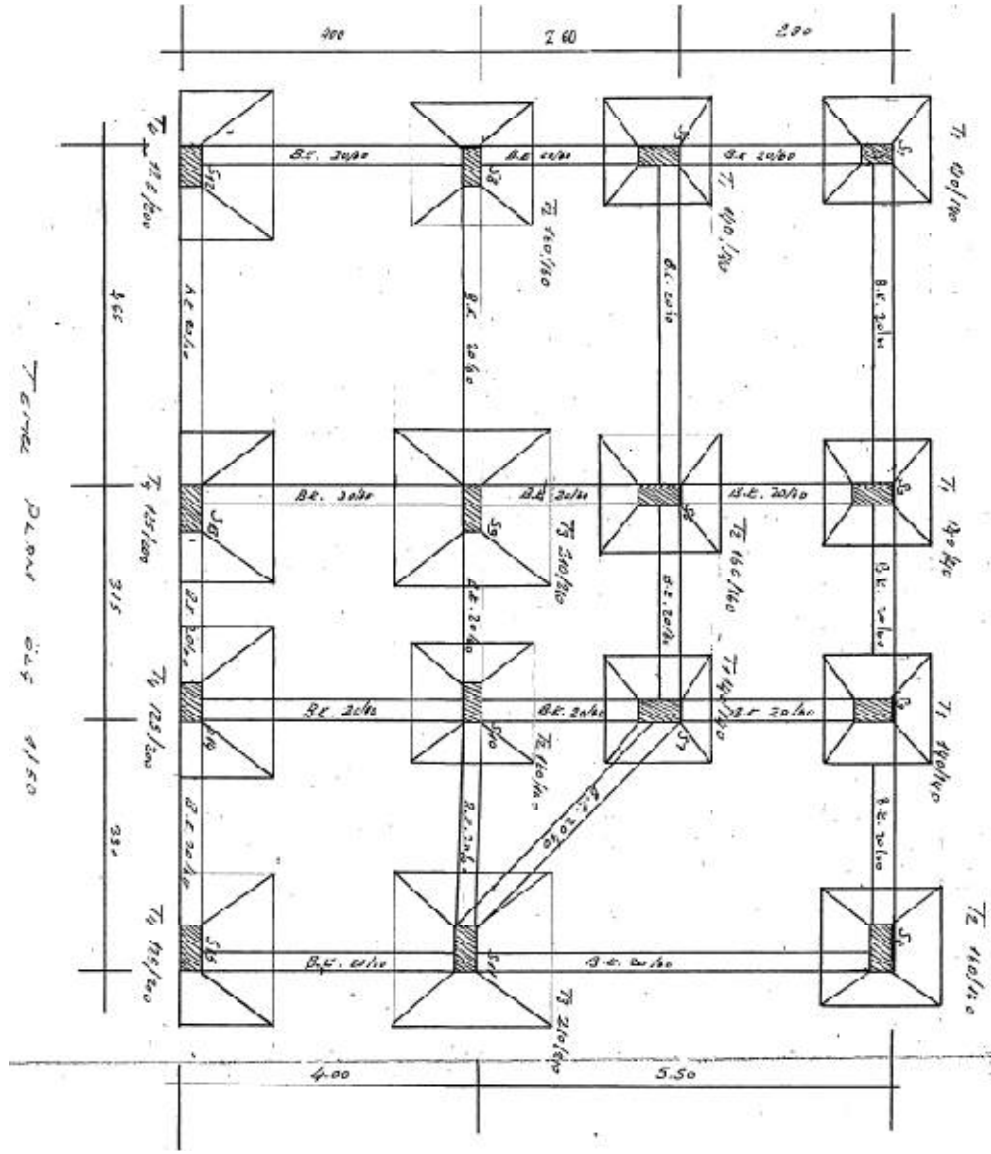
(1) Nolu bina temel aplikasyon planı
